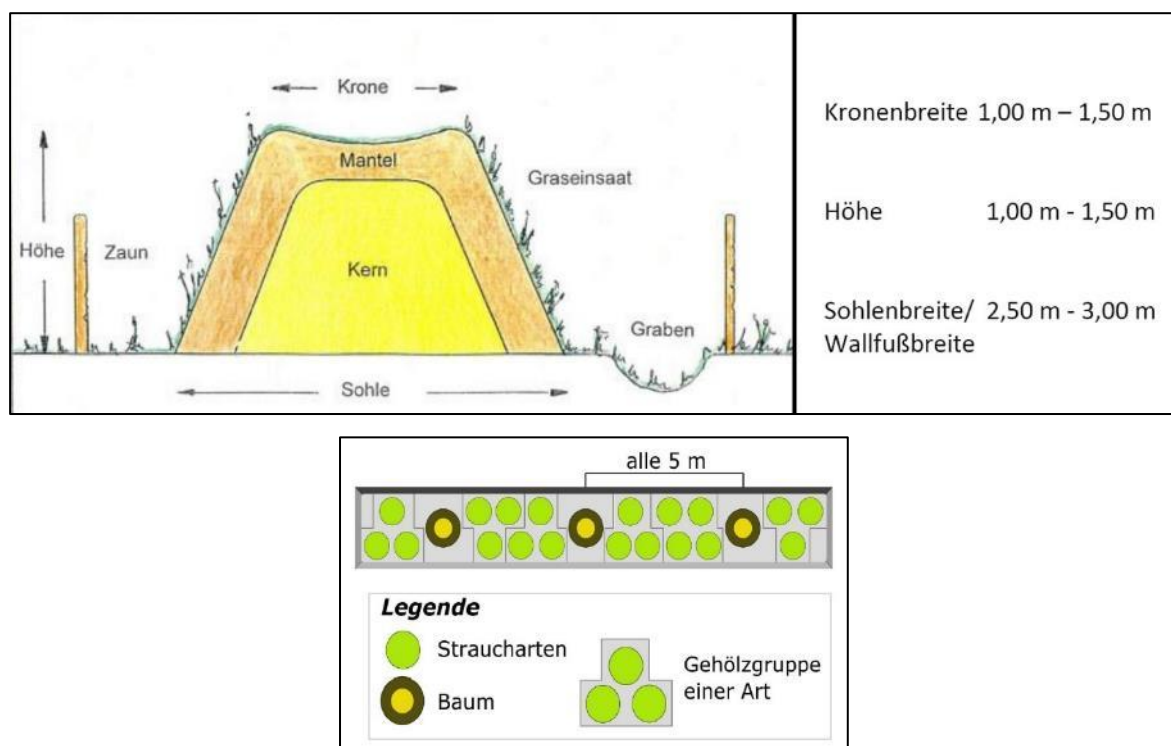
Aufbau des Walkörpers und Pflanzschema
